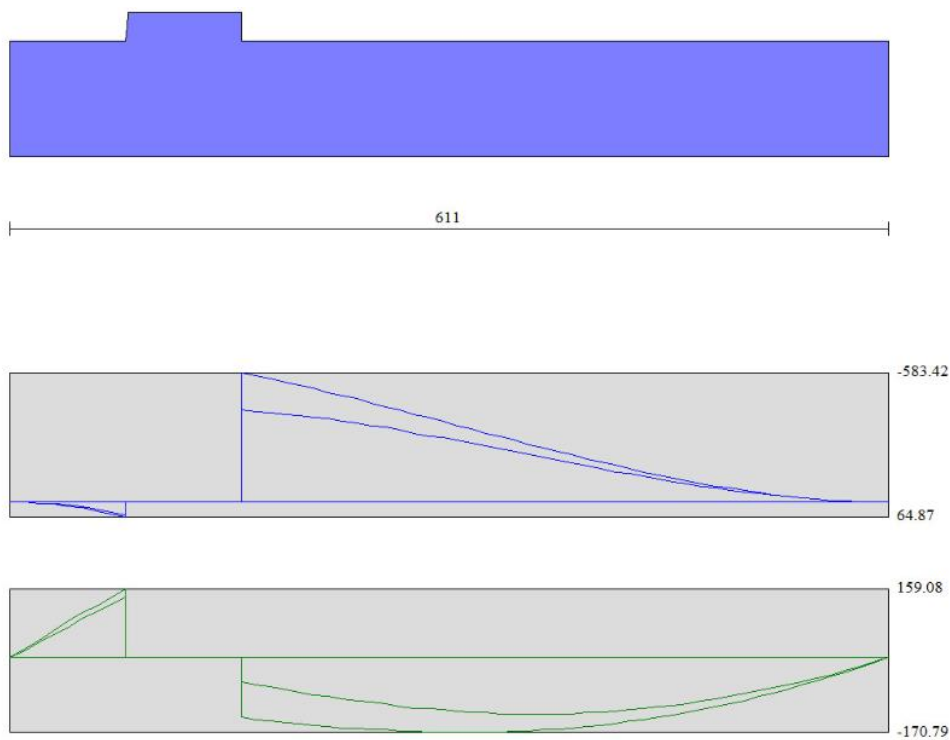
Inviluppo delle sollecitazioni SLU e SLV sulla ciabatta di fondazione
